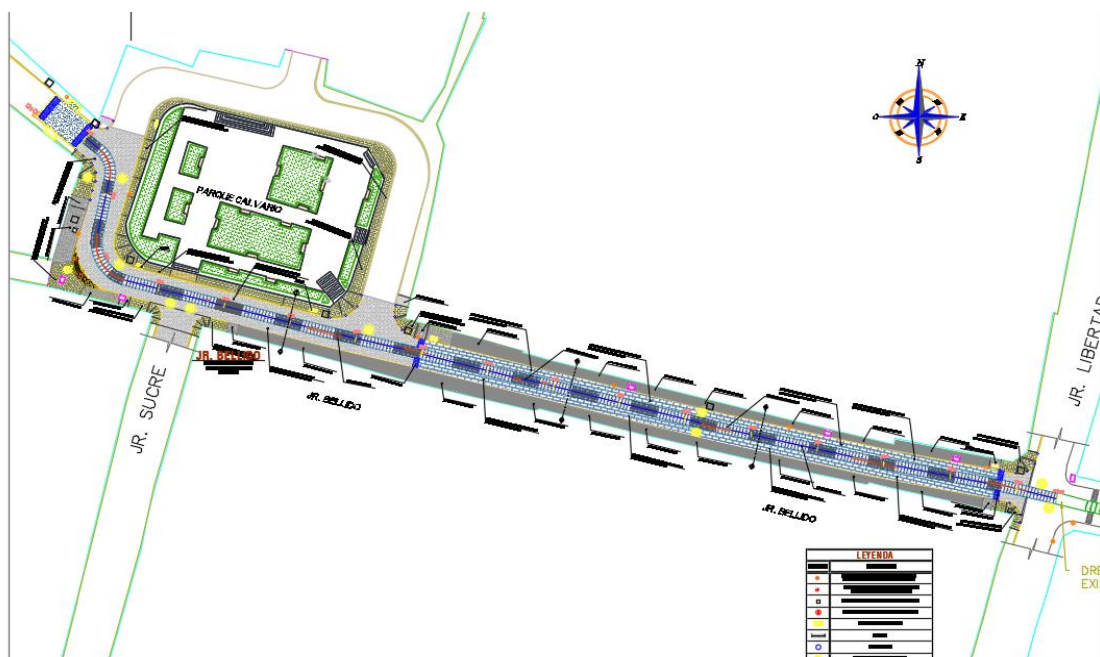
Plano de arquitectura del Jr. Bellido culminado.
